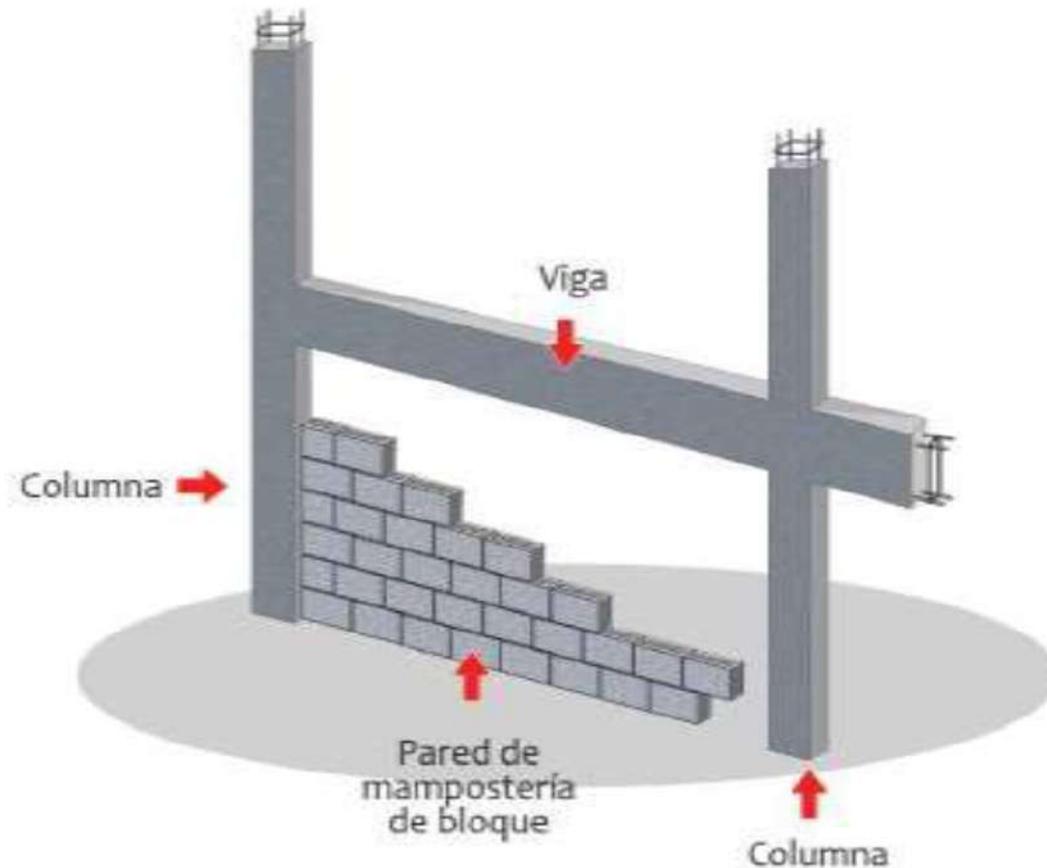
Muro no estructural: paredes de mampostería se construyen luego de columnas y vigas
